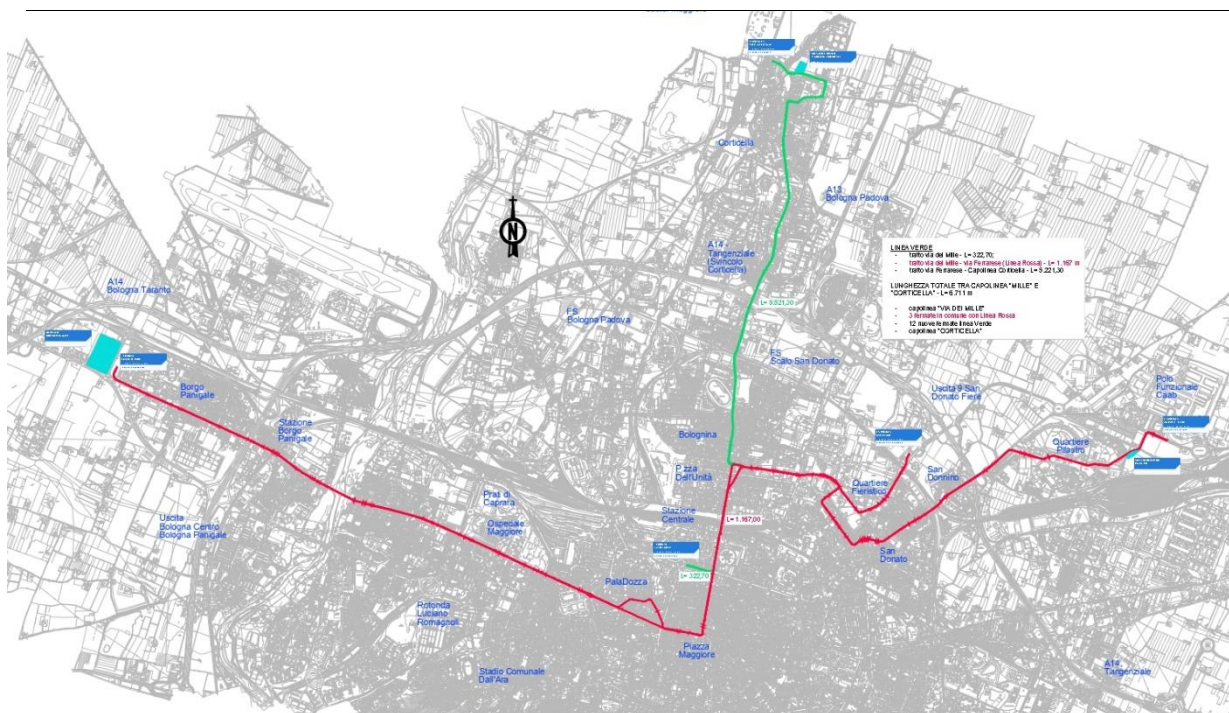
Planimetria generale Linea rossa + Tratta nord Linea Verde
